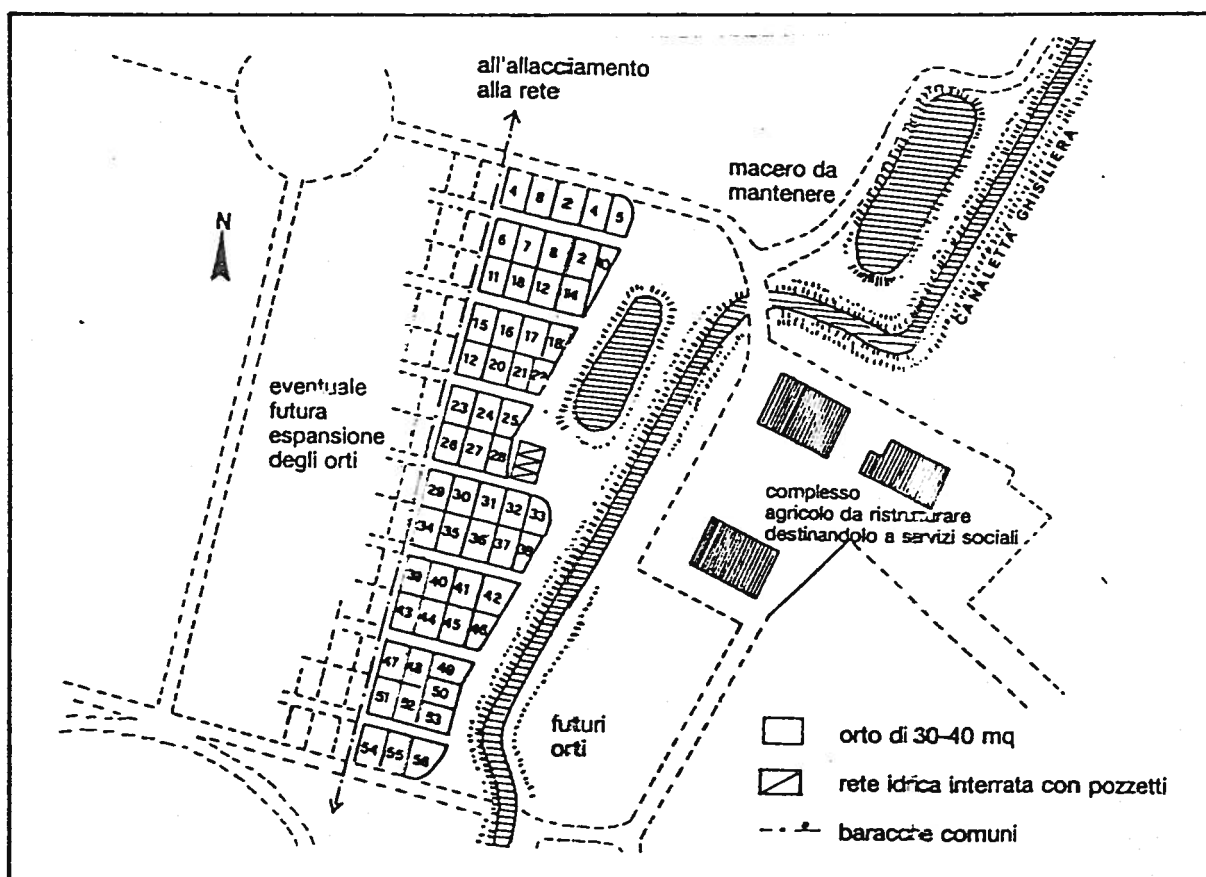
Planimetria di un complesso di orti urbani a Bologna all'interno di un'area P.E.E.P.
